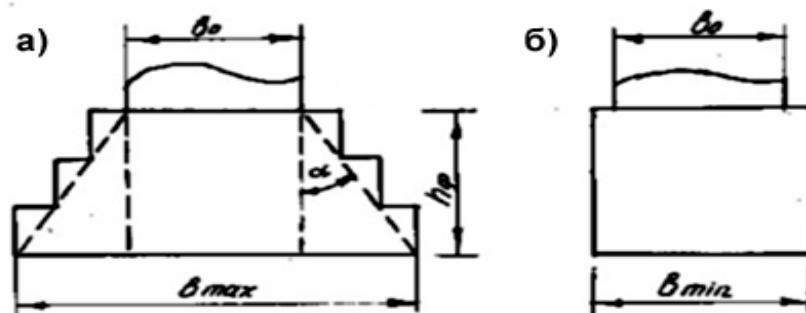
Фундаменти: а – з розширеною підшовою; б – без розширення.
